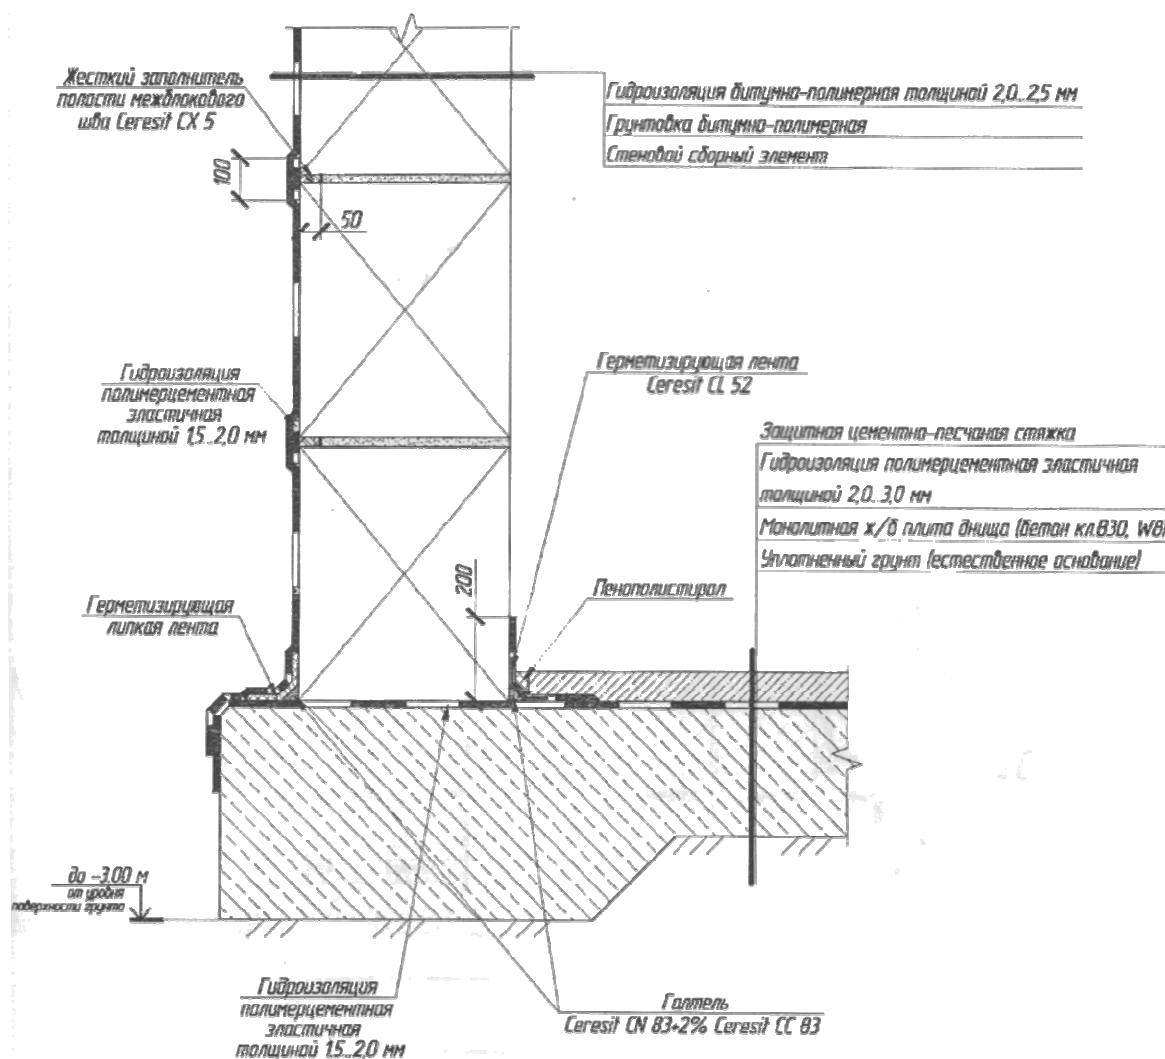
Комбинированная гидроизоляция: внутренняя гидроизоляция бетонных плит основания и наружная гидроизоляция стен подземных сборно-монолитных сооружений в условиях воздействия грунтовой влаги
